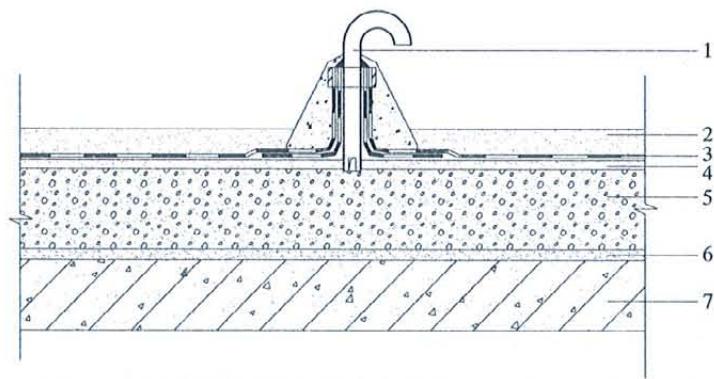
现浇轻质泡沫混凝土屋面体系构造示意
